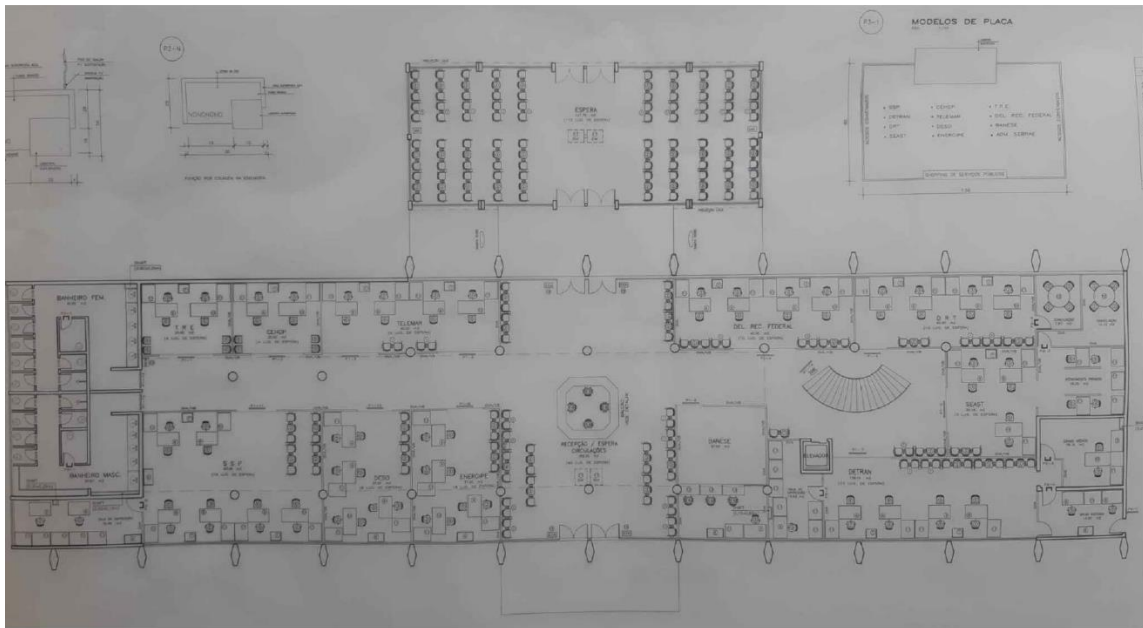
1999. / Planta do pavimento térreo. ©Planta conseguida na CEHOP.
